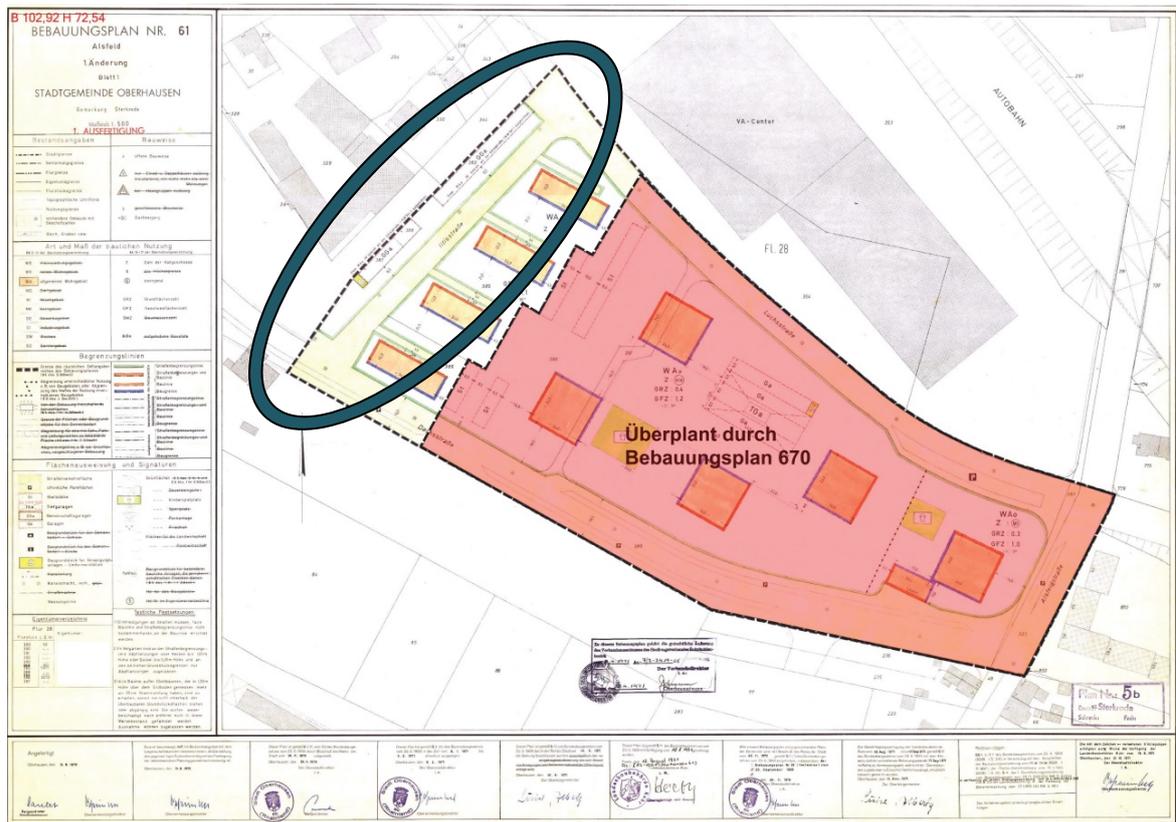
B-Plan Nr. 61, 1. Änderung © Stadt Oberhausen
